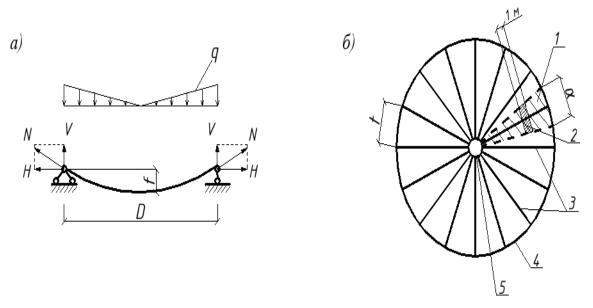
Расчетная схема висячей оболочки с радиальными вантами (а) и план покрытия (б): 1 – грузовая площадь ванты, 2 – грузовая площадь на 1 п. м ванты, 3 – ванты, 4 – внешнее опорное кольцо, 5 – внутреннее опорное кольцо
